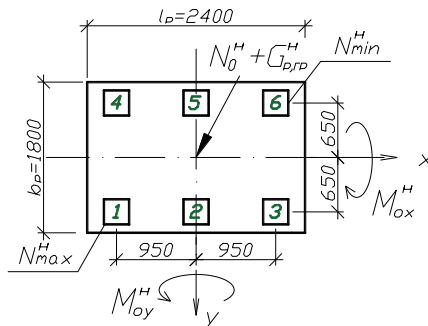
Схема к определению нагрузок на сваи № 1–6
